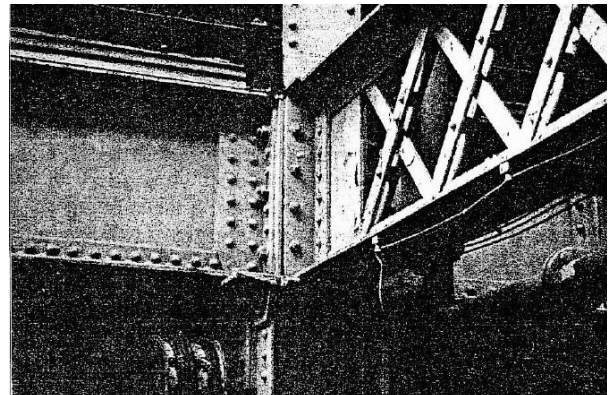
Detalle de la unión estructural enThe Guinness Brewery.
